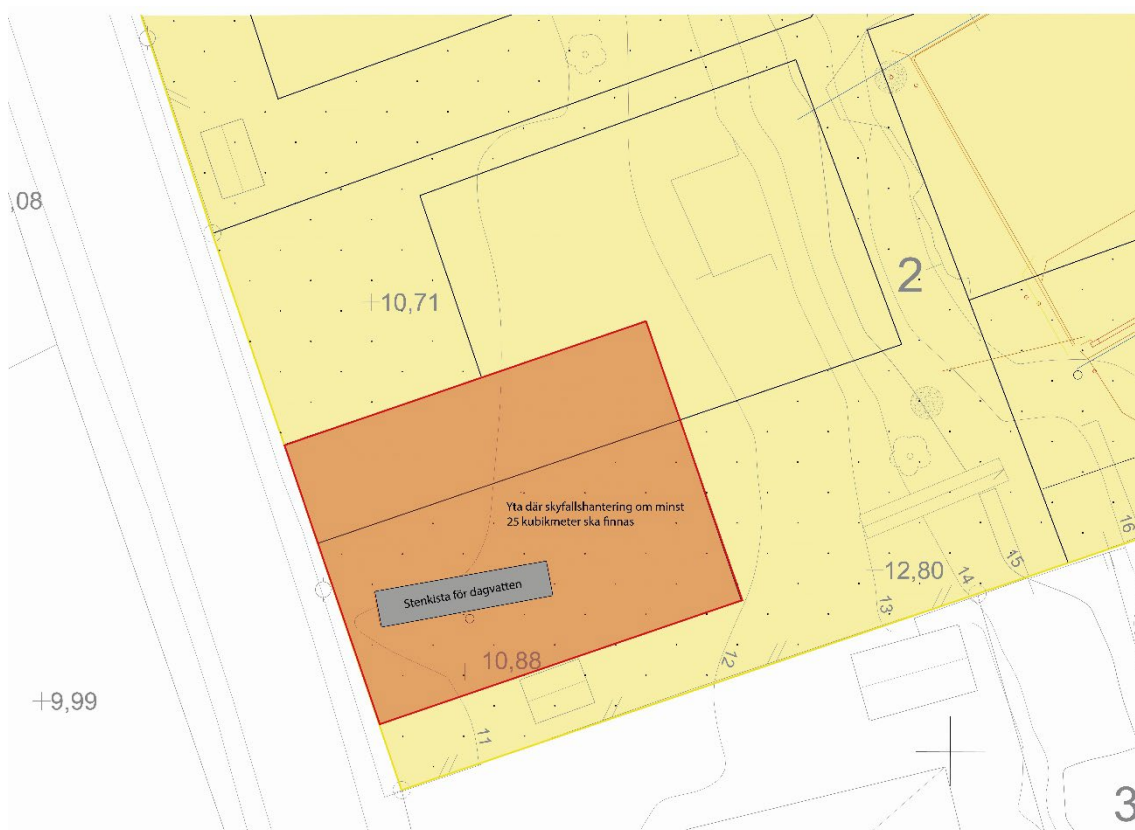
Planförslagets åtgärder för skyfallshantering enligt framtagna skyfallsutredning (Sweco 2025).
